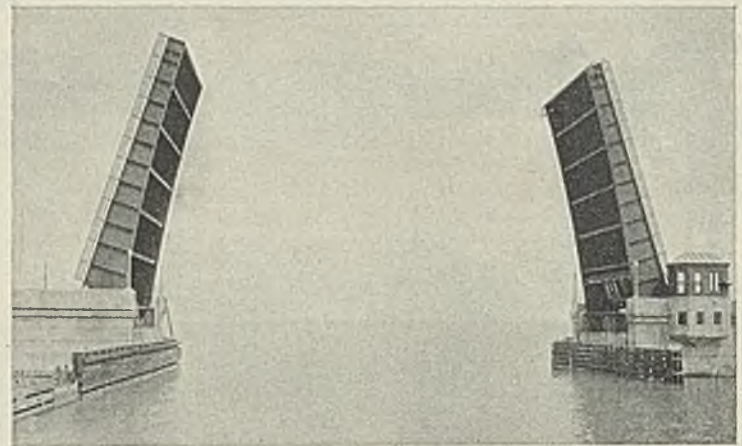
Klappbrücke (Abb. 25) geöffnet.
